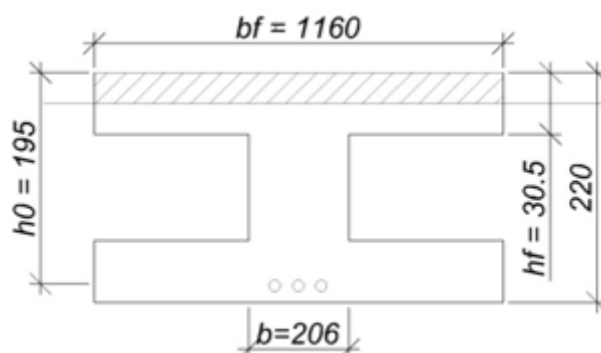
Розрахунковий перетин круглопустотної плити
